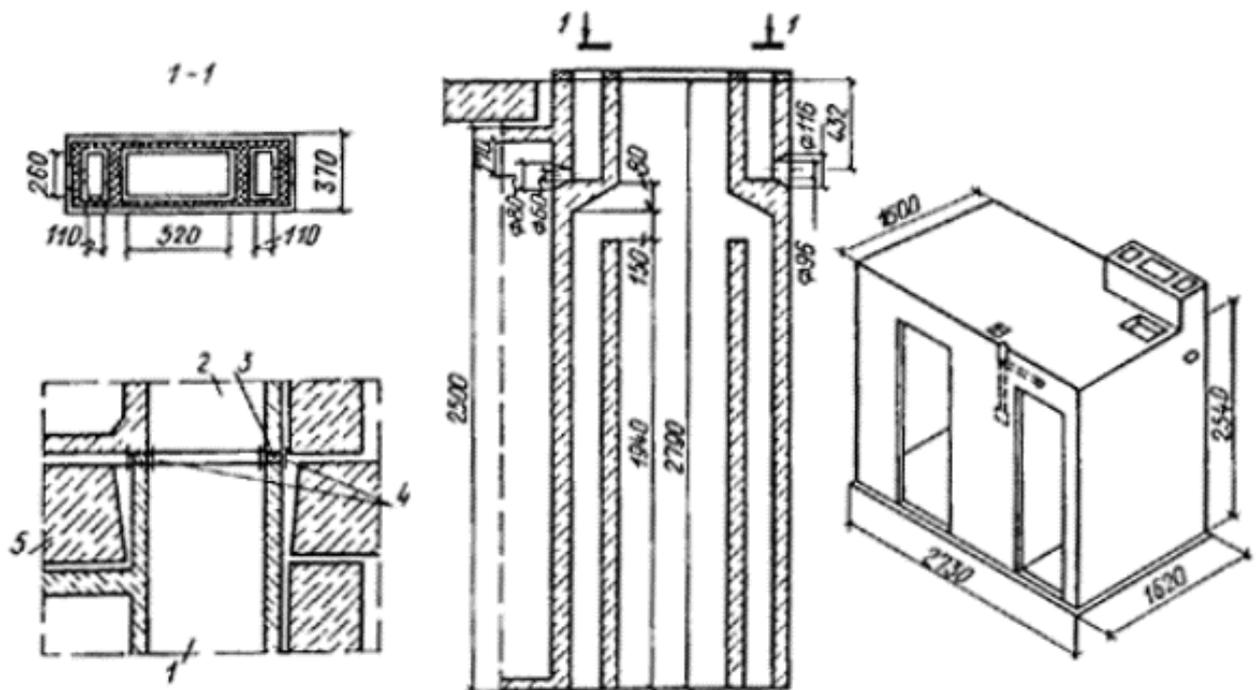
Обозначение приставных железобетонных вентиляционных каналов
